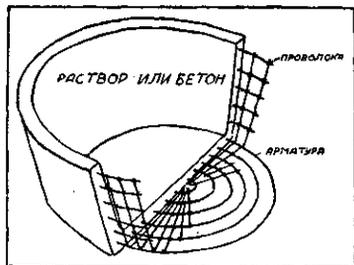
Железобетонная лодка по проекту Ламбо на всемирной выставке в 1854 г.
